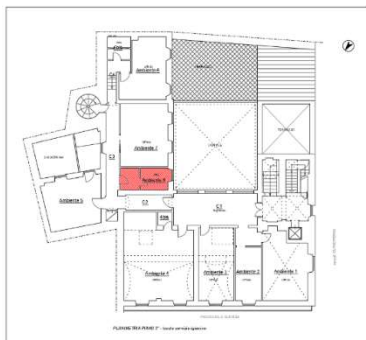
Planimetria piano terzo Palazzo Ossoli – servizio igienico da adeguare per disabili
